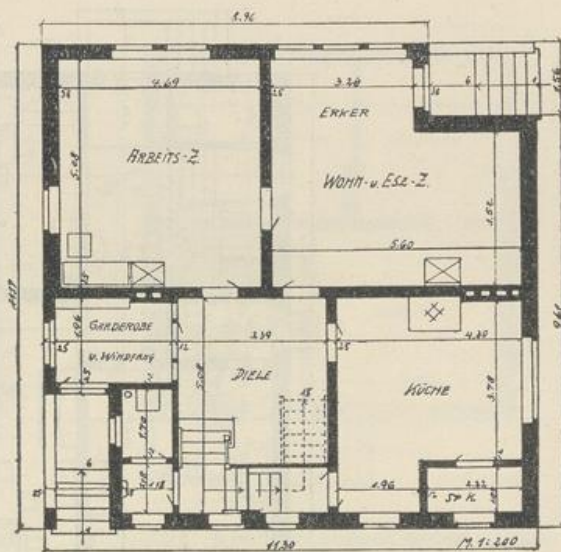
Landhaus. Dreiarmige Podesttreppe. Abort mit Vorraum, vom untern Podest zugänglich. Arbeitszimmer am Windfang mit Garderobe. Eßzimmer mit Erker und Treppe nach dem Garten. Gehört zu Aufg. X, Seite 173.
